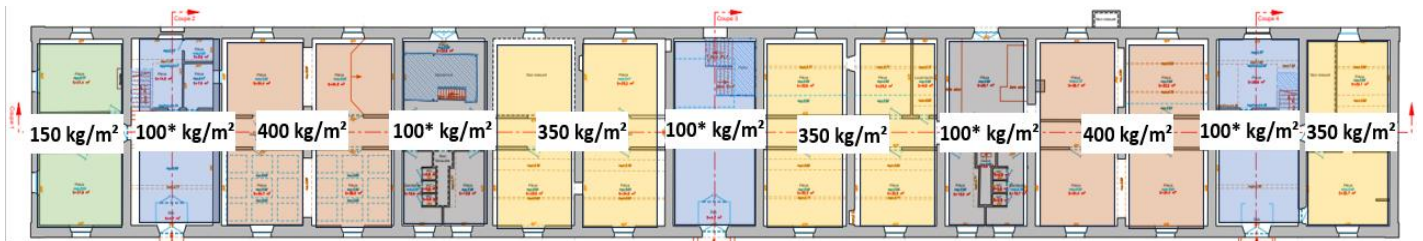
charges admissibles sur le plancher haut du RDC soit le plancher bas du R+1
